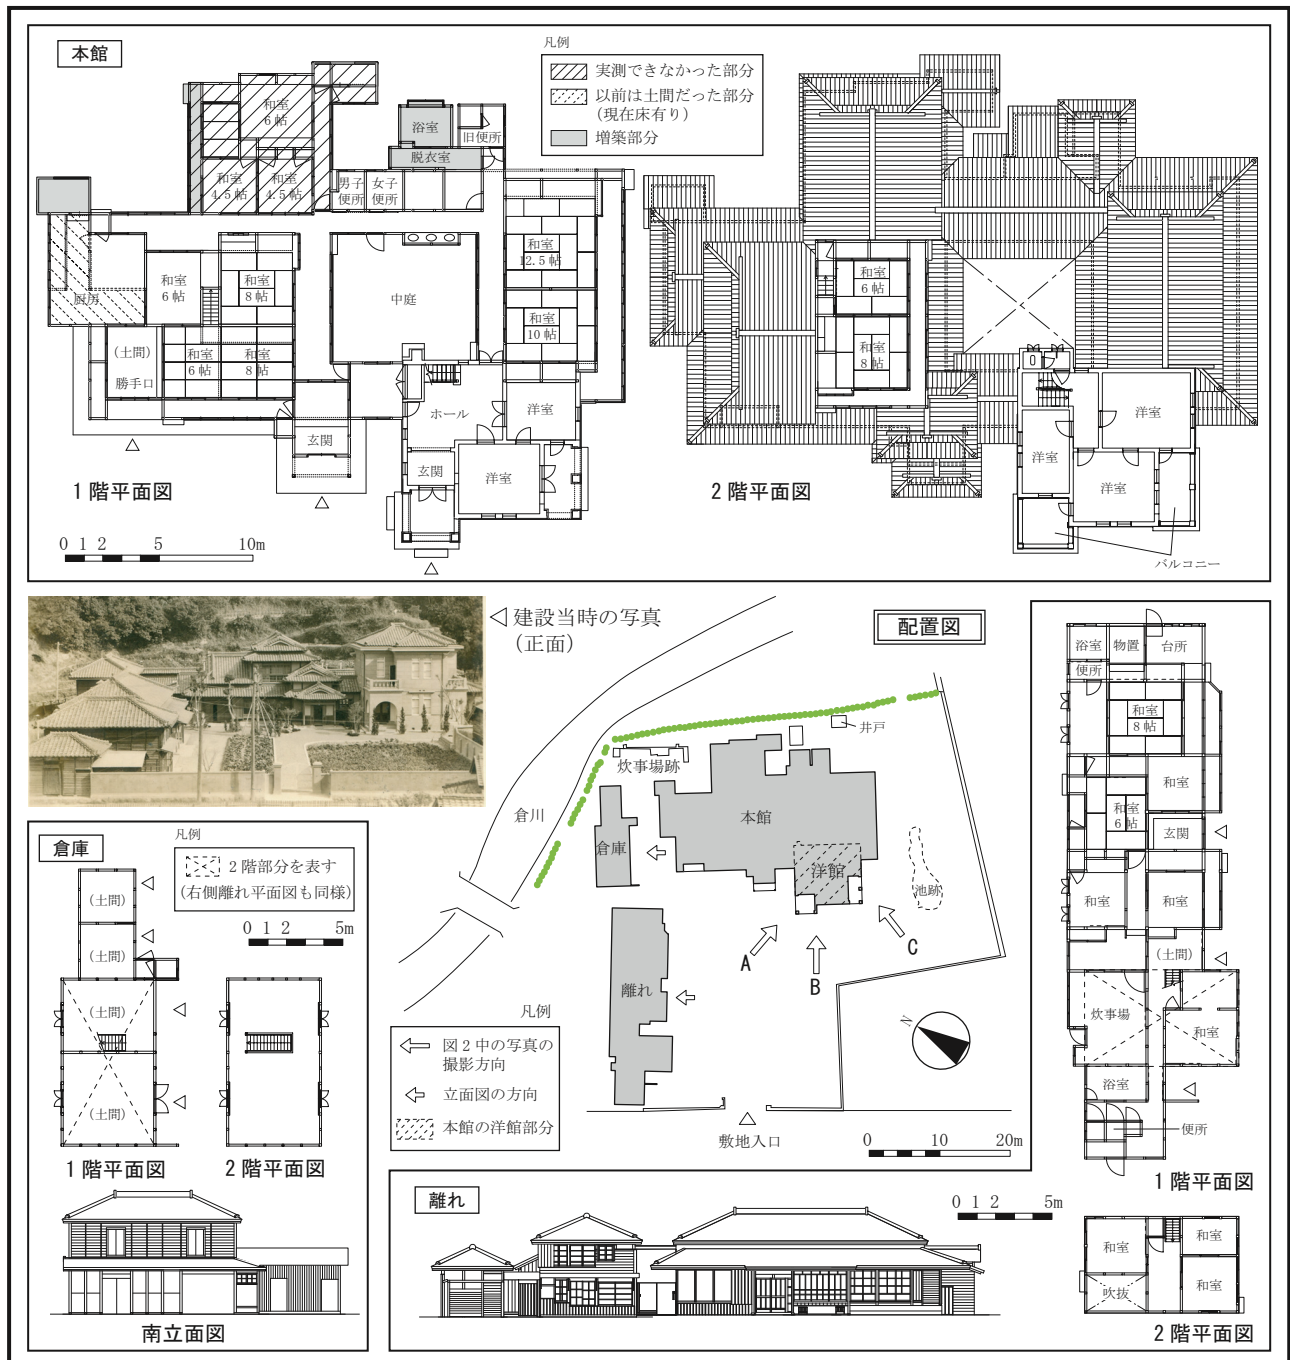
旧赤崎邸（旅館白磯）の実測による配置図と平面図
